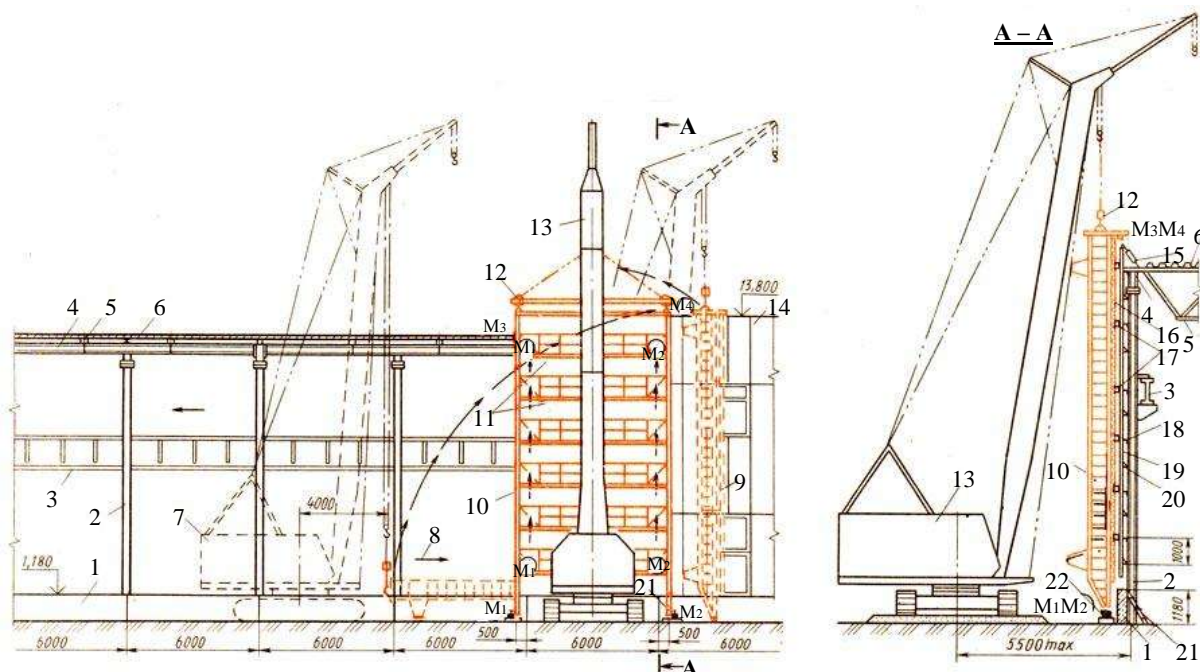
Схема монтажу стінових панелей: 1 – цокольні панелі; 2 – колони; 3 – підкранові балки; 4 – підкрокв'яні балки; 5 – крокв'яні ферми; 6 – покриття із профнастилу; 7, 13 – монтажний кран; 8 – напрям руху крана; 9 – збірно-монтажний пристрій під час збирання та піднімання стінових панелей; 10 – те саме під час установлення; 11 – майданчики-риштування; 12 – монтажна траверса; 14 – змонтовані панелі; 15 – гвинтова стяжка; 16 – стінова панель; 17 – ригель; 18 – опорні стіл для кріплення ригелів до колони; 19 – драбина навісна; 20 – східець відкідний; 21 – драбинка; 22 – домкрат; М₁–М₄ – робочі місця монтажників
